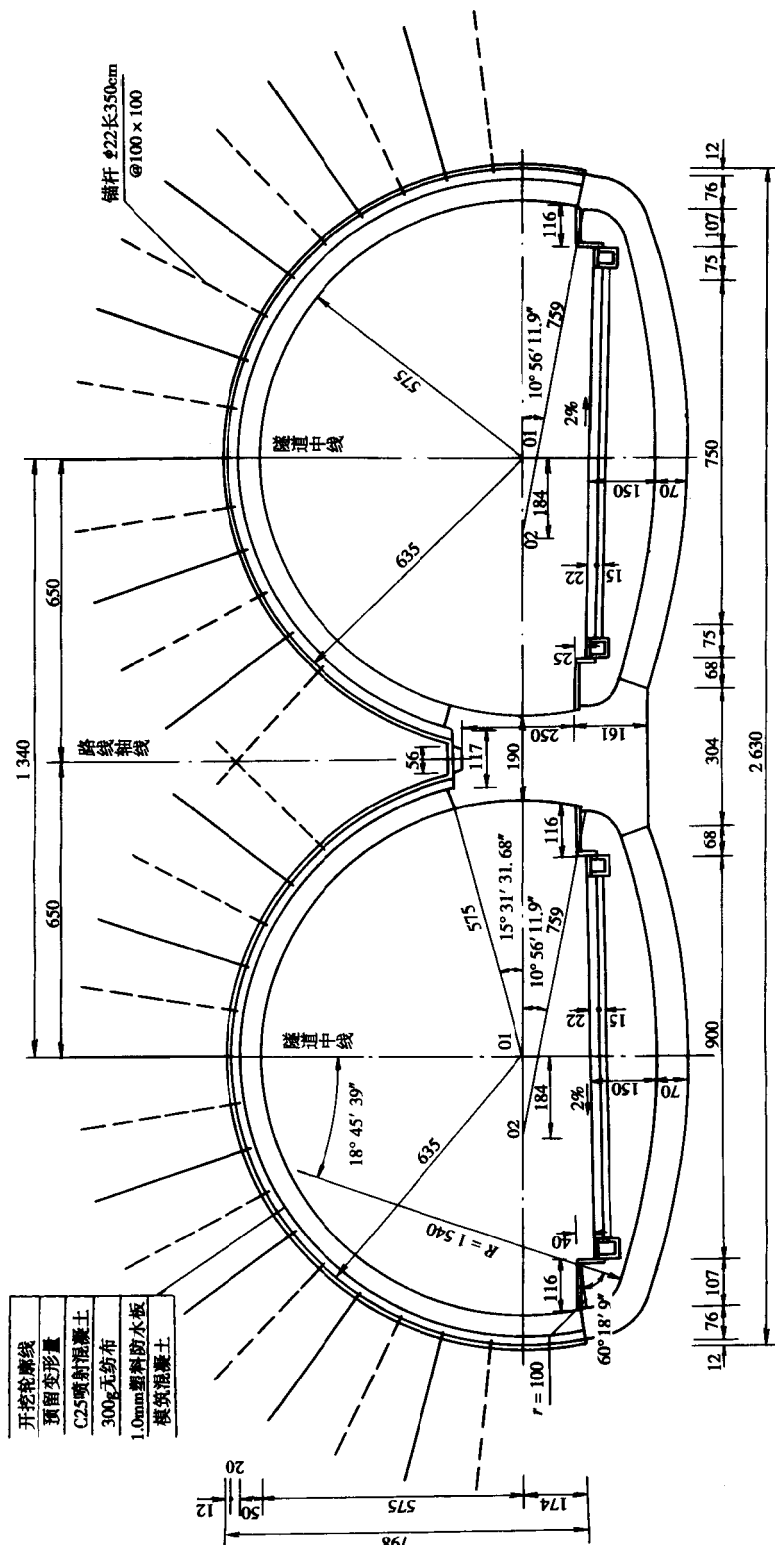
III 类衬砌断面图(尺寸单位:cm)
